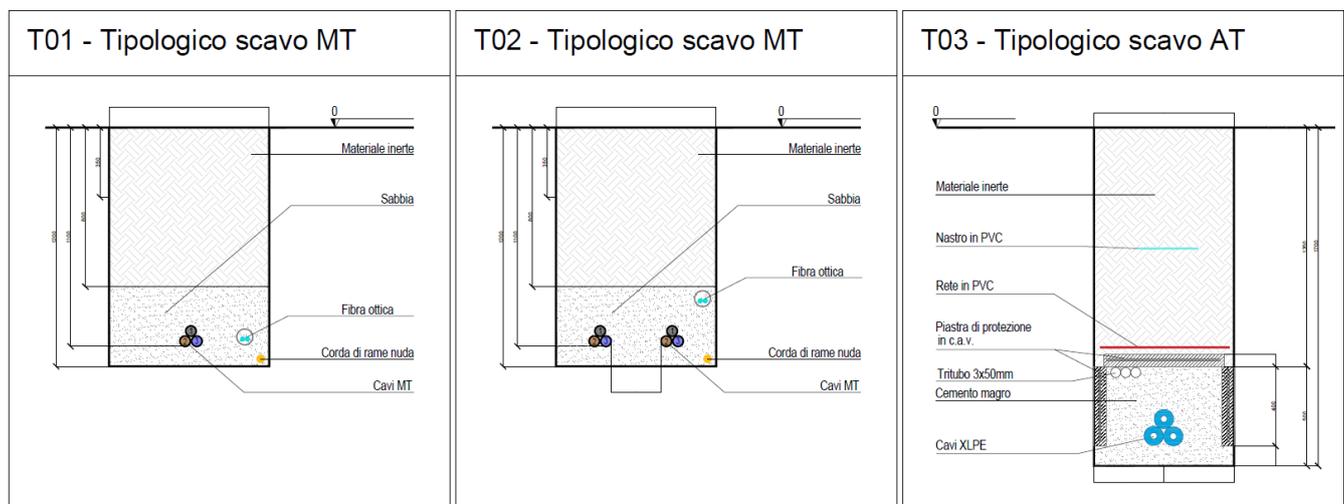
Tipico posa cavidotto su sterrato e su pavimentazione in c.b.
